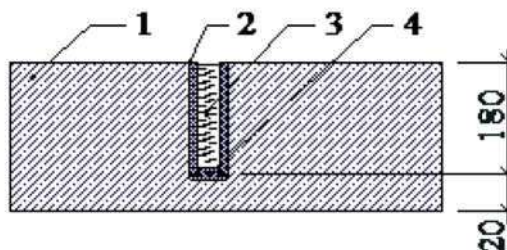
Устройство температурной скважины: 1 - бетон плиты перекрытия; 2 трубка ПВХ 25; теплопроводная жидкость - масло; 4 - заглушка
